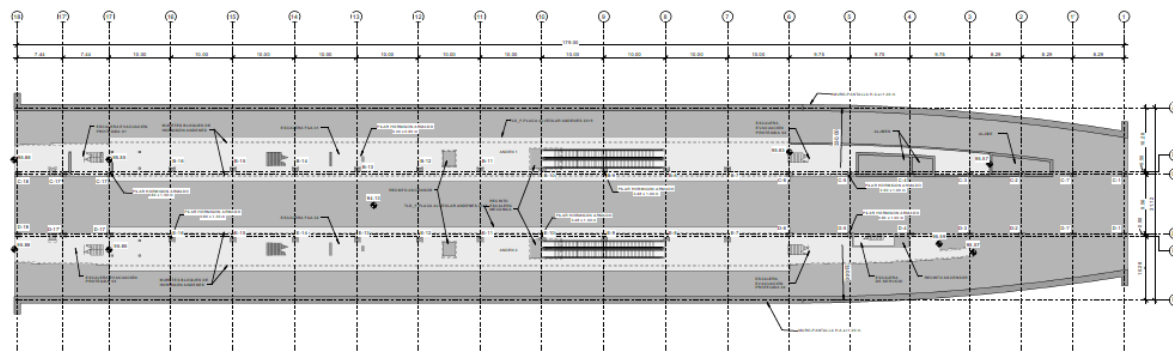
Planta de andenes de la estación (fuente: PC estación de Telde)
